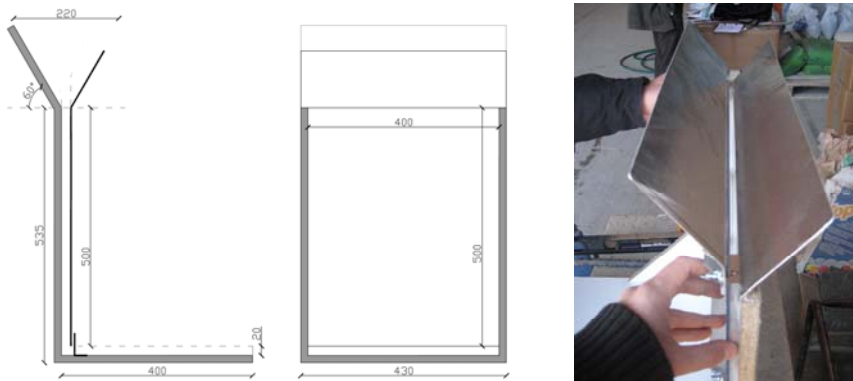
Molde vertical para ensayo de vertido de hormigón. Entrada para el hormigón.
